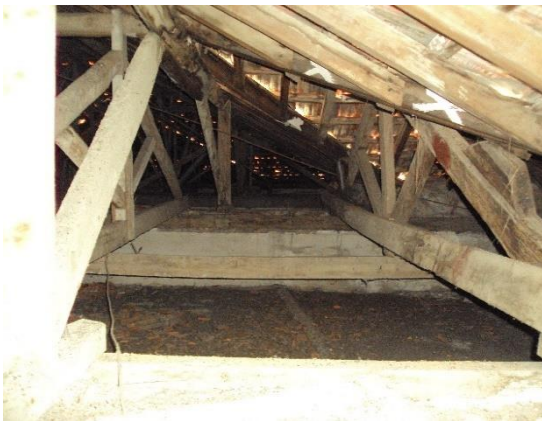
Estrutura de Madeira da cobertura. [FONTE: Autor]
